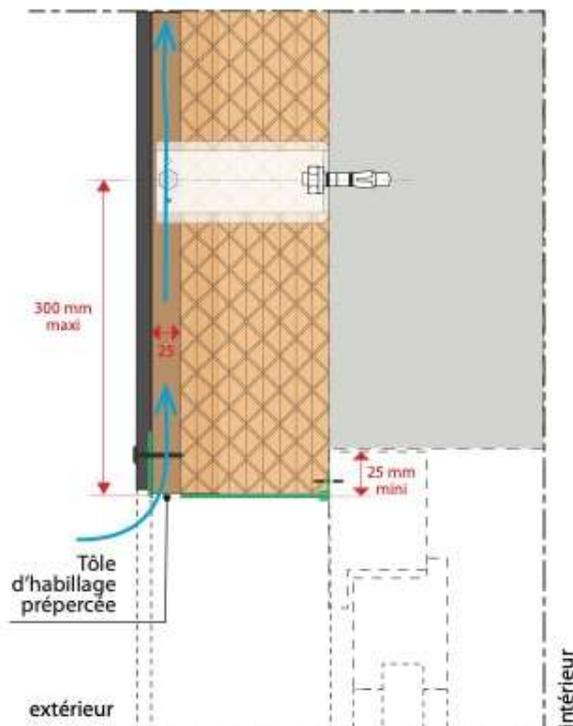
Coupe sur linteau de baie posée en tunnel au nu extérieur
